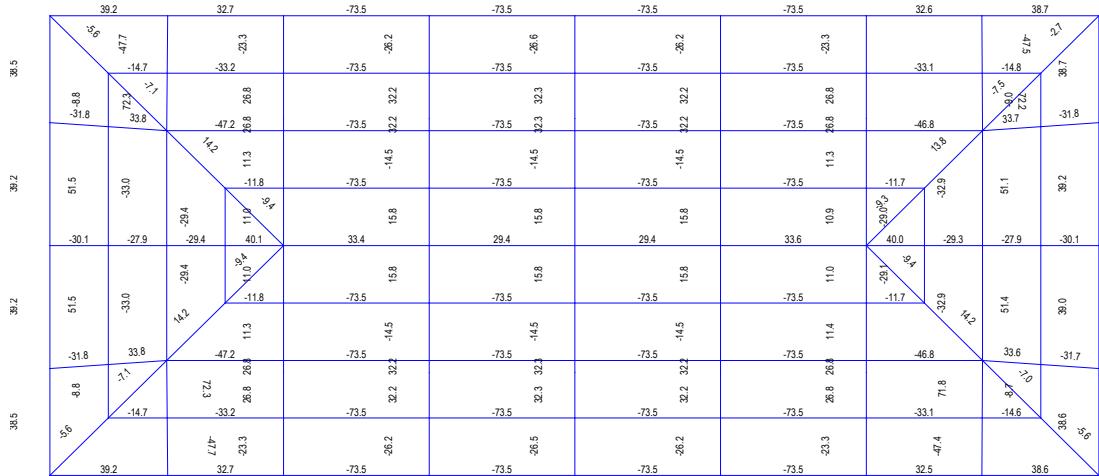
構架 D+L 擁曲應力（屋面構架）
